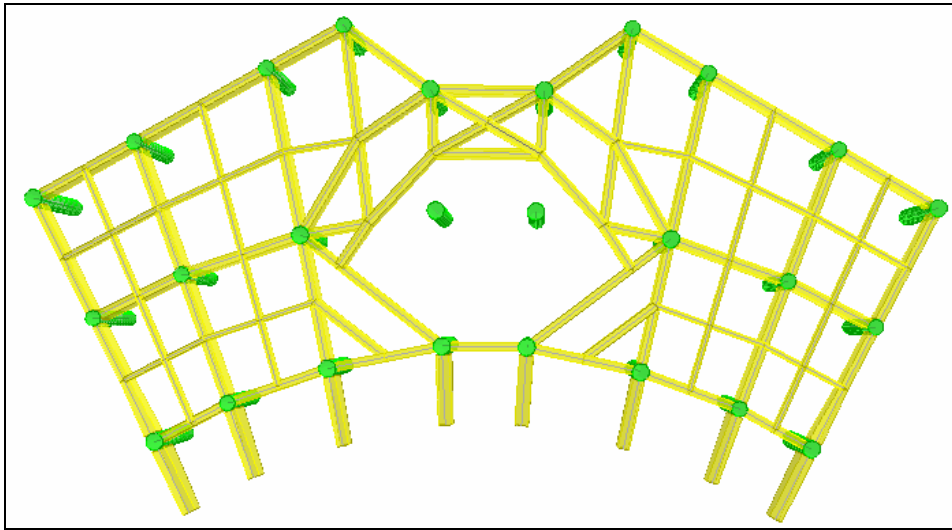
Nueva distribución de vigas y columnas para la platea alta.
